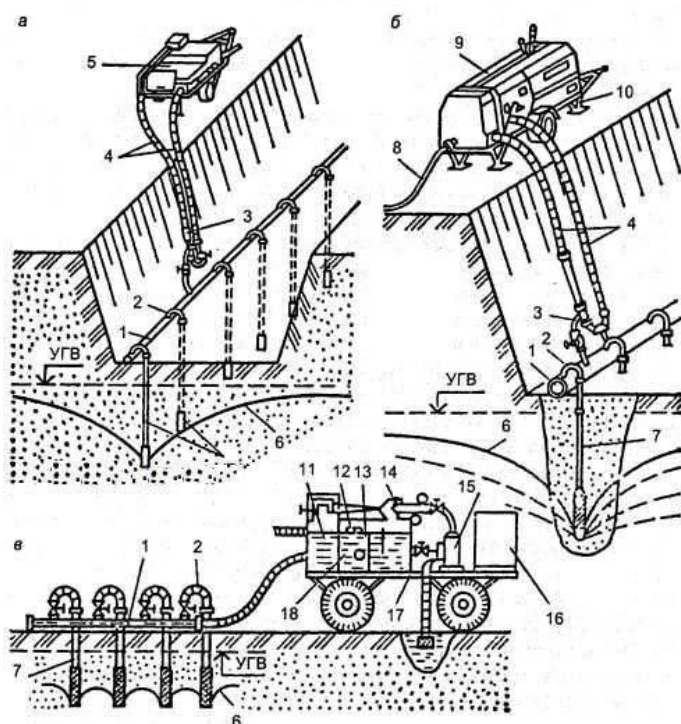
Передвижные установки вакуумного водопонижения: а - схема водопонижения с помощью установки ПУВВ-1М; б - то же, установки ПУВВ-3Д; в - установка ПУВВ-4; 1 - водосборный коллектор; 2 - соединительный рукав; 3 - водоструйный насос; 4 - рукава; 5 - передвижной насосный агрегат; 6 - кривая депрессии; 7 - иглофильтры; 8 - сбросной рукав; 9 - приводная станция; 10 - опоры; 11 - распределительная камера; 12 - датчик уровня; 13 - вакуумная камера; 14 - агрегат водоструйного насоса; 15 - центробежный насос; 16 - двигатель внутреннего сгорания; 17 - ходовая часть; 18 - клапан
